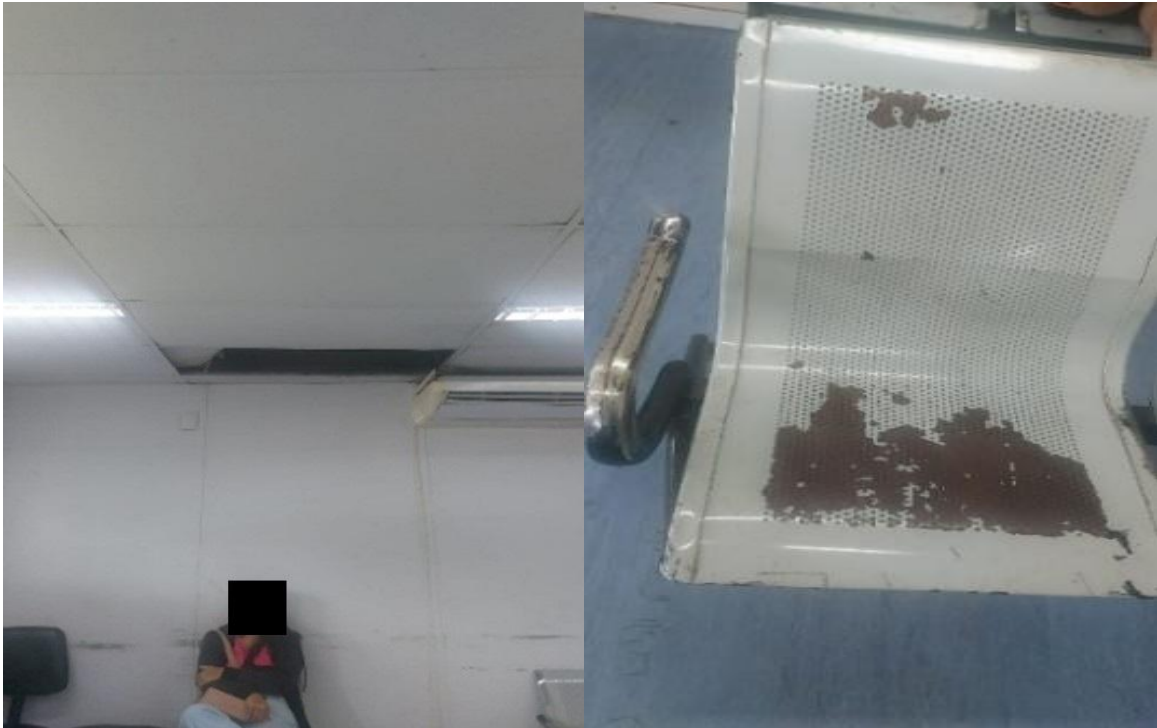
Buraco no teto e cadeira enferrujada na recepção da unidade – Marataízes
